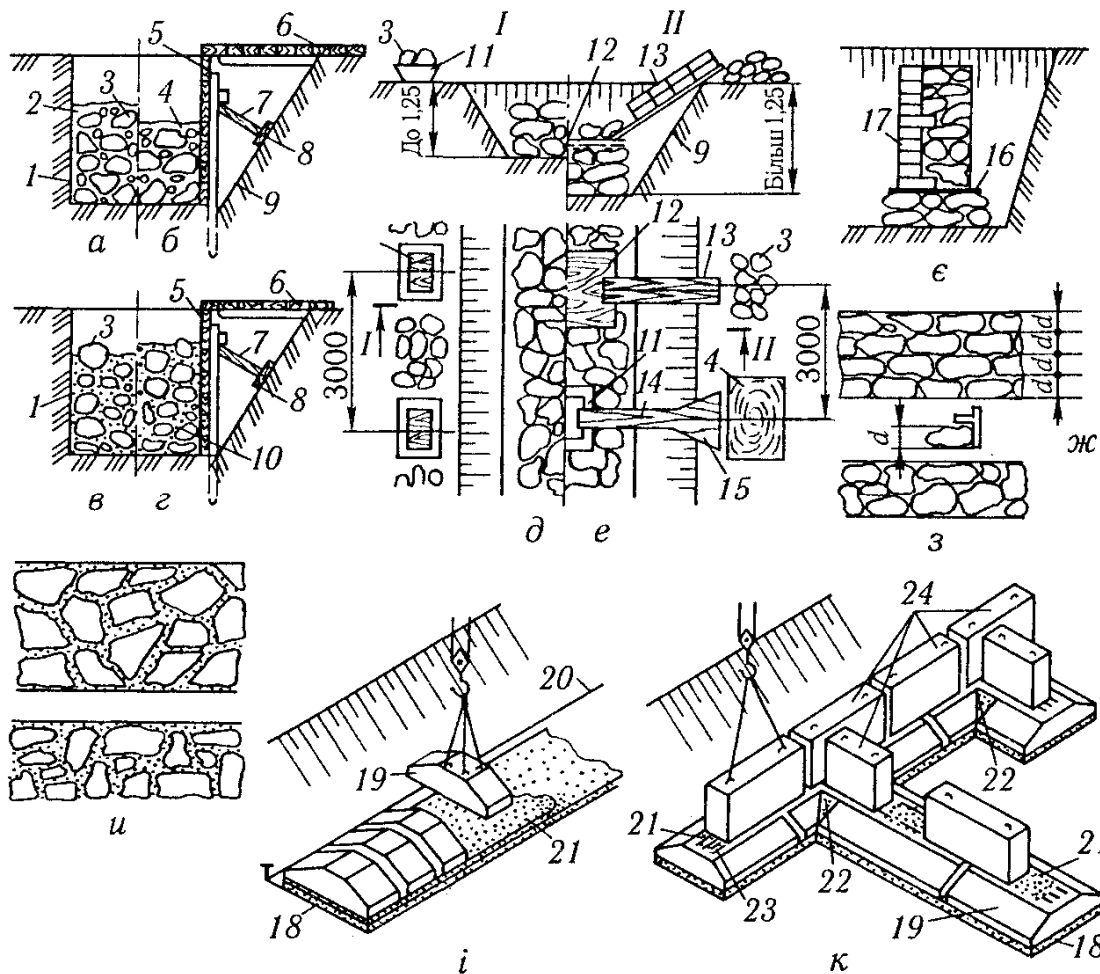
Зведення конструкцій підземної частини будівлі з бутового каменю і великих бетонних блоків: *а, б* – кладка стрічкових фундаментів із бутового каменю під залив у розріз відповідно з ґрунтовою стінкою і опалубкою; *в, г* – те саме, з бутобетону; *д, е* – те саме, під лопатку, відповідно до 1,25 м завглибшки; *є* – те саме, з одночасним облицюванням цеглою; *ж, з* – кладка стін з бутового каменю під скобу, відповідно план і фасад; *и* – те саме, циклопічна; *і, к* – зведення фундаментів і стін підвалу із великих бетонних блоків; *1, 9* – траншеї з вертикальними і похилими стінками; *2* – щебінь; *3* – бут; *4* – цементний розчин; *5* – опалубка; *6* – робочий настил; *7* – підкіс; *8* – підкладка; *10* – бутобетон; *11* – ящик для розчину; *12* – дерев'яний щит для приймання бутового каменю; *13* – жолоб для подавання буту; *14, 15* – лоток для подавання розчину; *16* – гідроізоляція; *17* – кладка з лицевої цегли; *18* – бетонна підготовка; *19* – фундаментний блок-подушка; *20* – причалка з дроту; *21* – постіль із розчину; *22* – бетон у примиканні; *23* – армований пояс; *24* – стінові блоки
